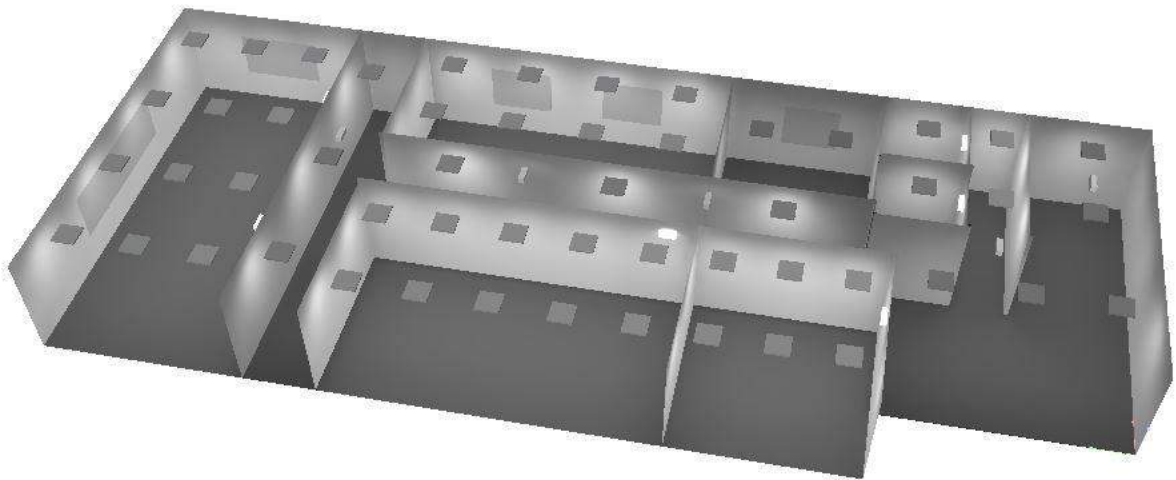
Vista 3D de la iluminación en la Planta Baja
